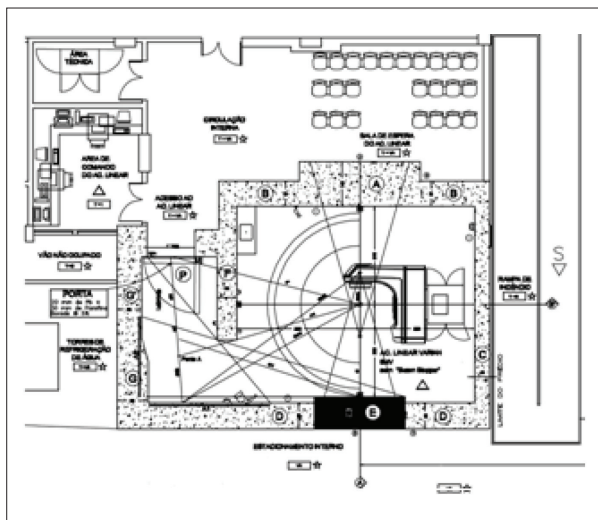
Layout do acelerador e áreas vizinhas consideradas no cálculo das barreiras de blindagem.
